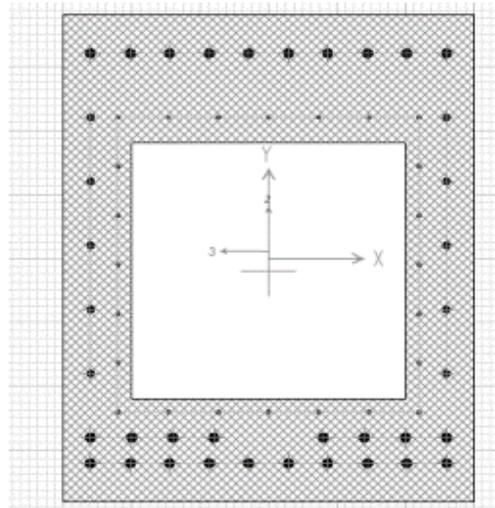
Viga para tubería DN 900mm. Modelado de la sección transversal en SAP 2000.
